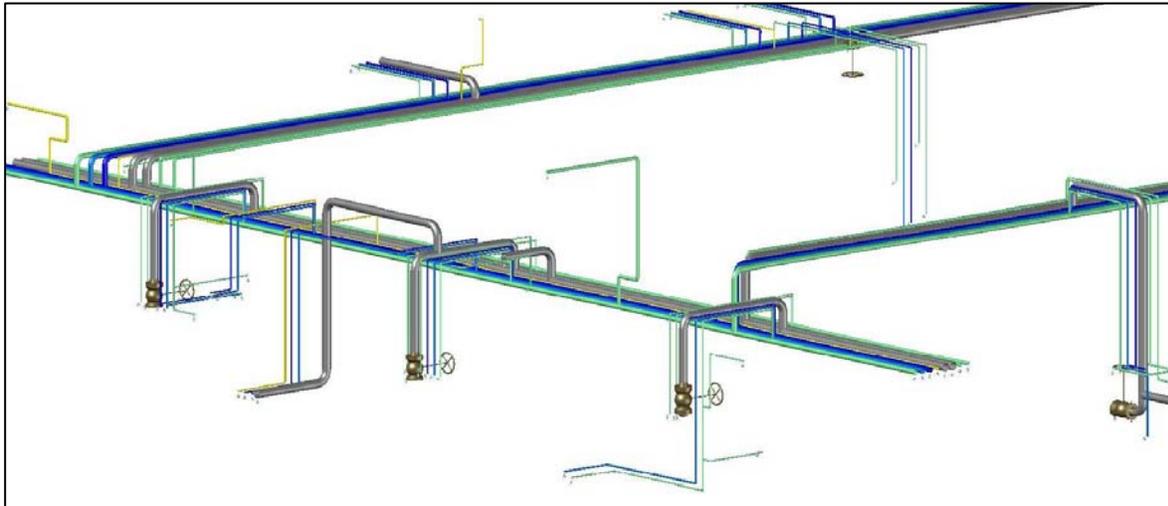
Modelo 3D de Tuberías en Planta Piloto FES Zaragoza (Vista 1).
